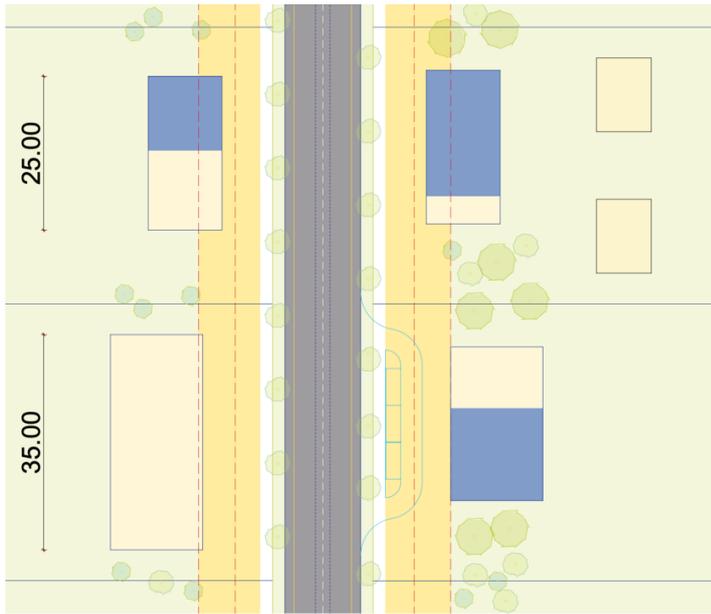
mögliche Anordnung im Grundriss (Darstellung unten links mit bestehender Gebäudelänge von 35 m (folglich ohne BMZ-Erhöhung und Höhenbonus)
